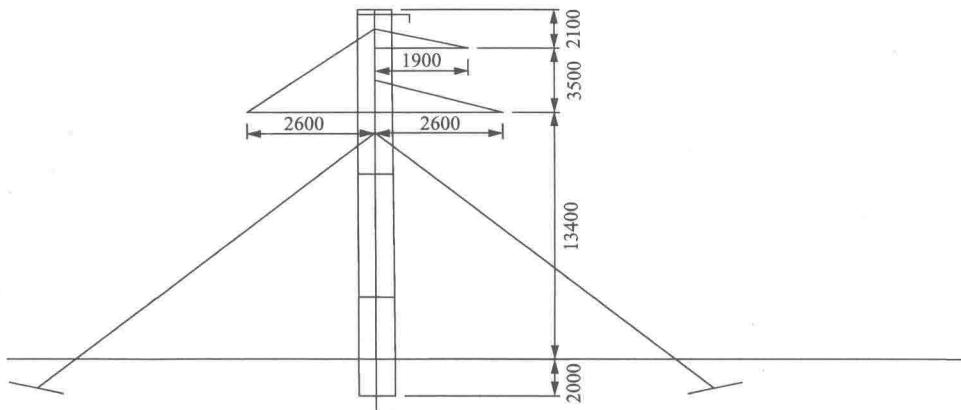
带拉线的钢筋混凝土直线单杆(单位:mm)
